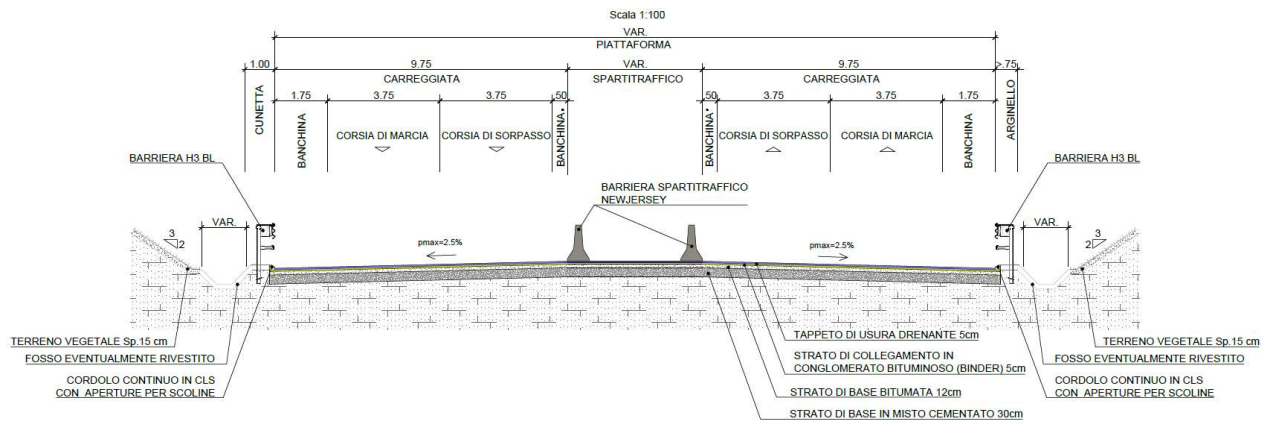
Sezione tipo in trincea in rettilo senza pista di servizio – Fosso trapezoidale
